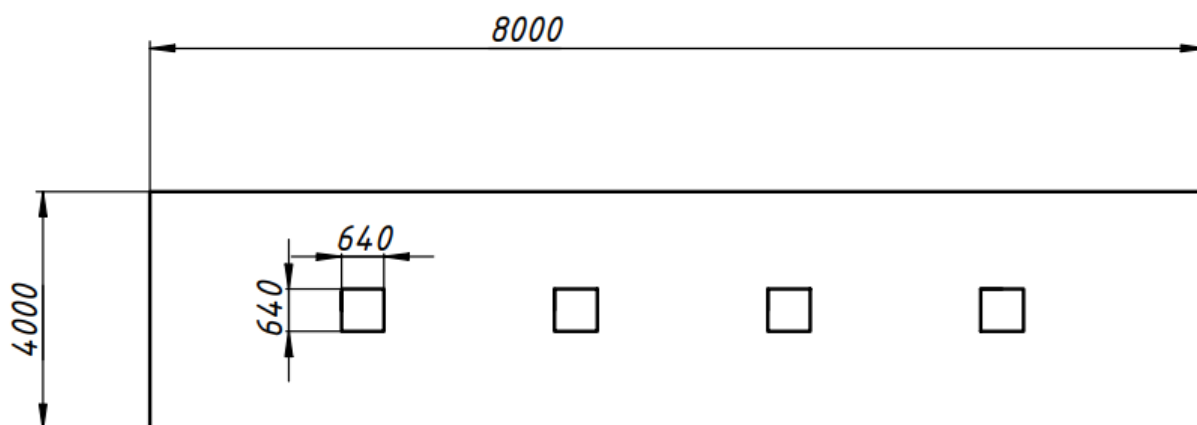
План размещения светильников в лаборатории 106 физического корпуса ТПУ.
